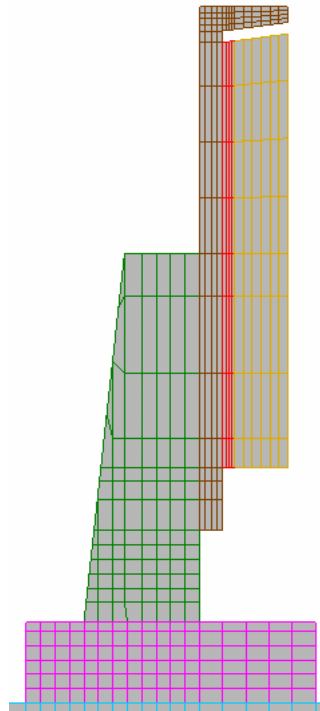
Corte transversal da proposta de reforço tipo 2
